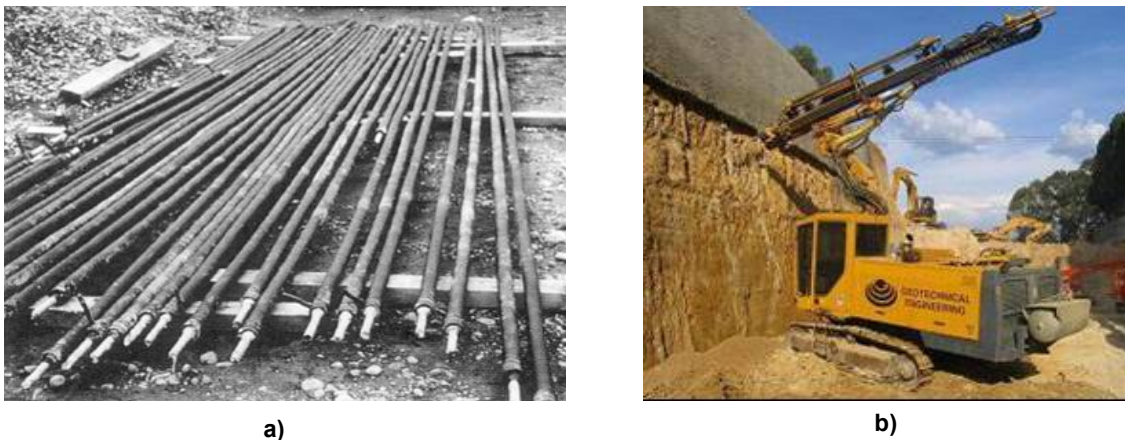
a) Barras de acero; b) Equipo de perforación para la instalación de los Nails.
